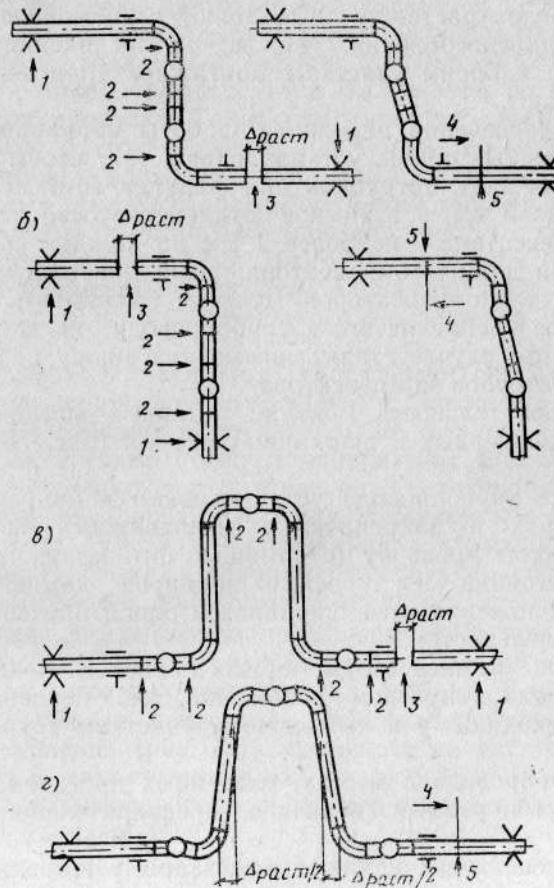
Монтаж угловых компенсаторов на трубопроводе
